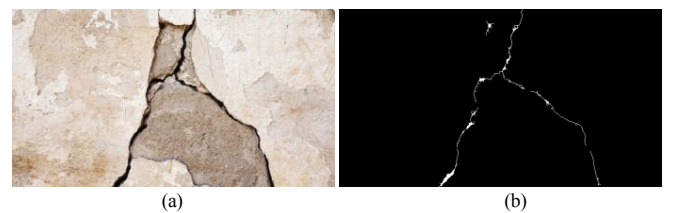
Imagen procesada de grieta en muro divisorio a) Imagen original a color y b) Forma y delimitación de la grieta detectada al finalizar su procesamiento.
